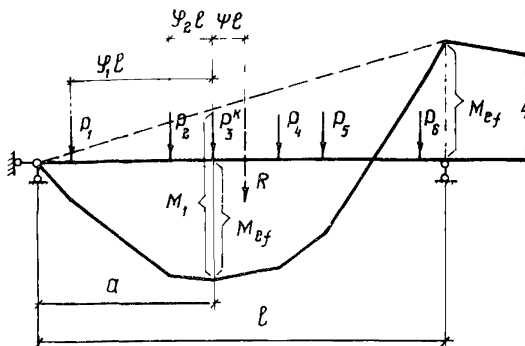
К расчету неразрезных балок при подвижных нагрузках
